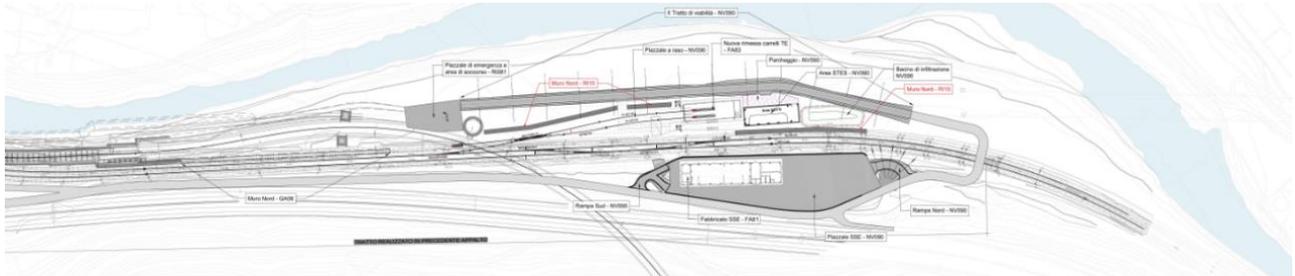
Interventi a Ponte Gardena: planimetria generale tratto NORD
